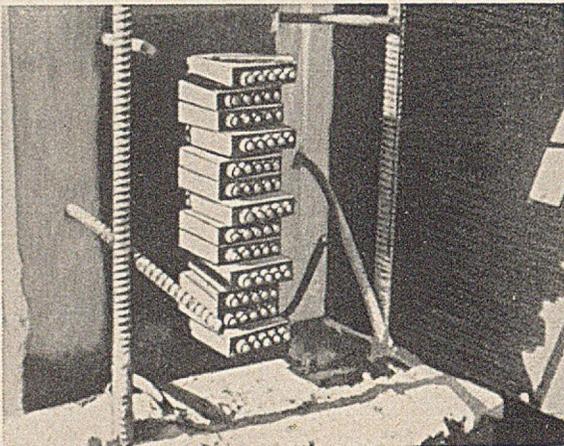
Spannblöcke. Einige Tage nach dem Betonieren werden einzelne Spannblöcke leicht herausgezogen. (Der Bleistift auf dem oberen Spannblock gibt einen Vergleichsmaßstab.)
